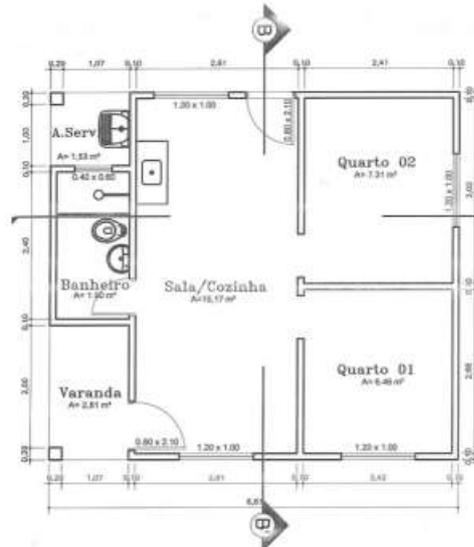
Planta de 39,64 m<sup>2</sup> do Governo do Estado
